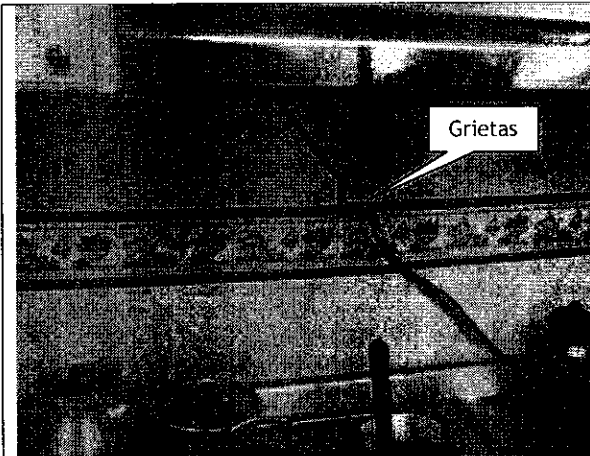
Vista de una fracción del muro localizado en la zona posterior del primer nivel (cocina), donde se observa la presencia de grietas que superan los dos (2) centímetros de abertura.
